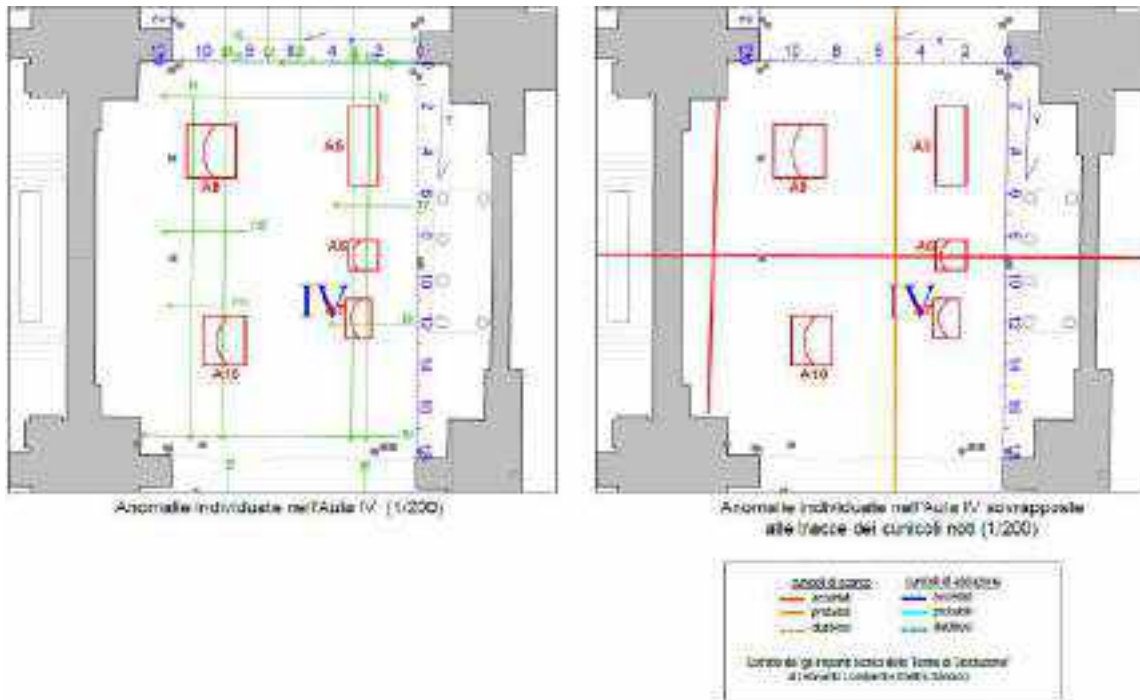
Planimetria dell'Aula IV con sezioni GPR e con sovrapposte le anomalie rilevate e le tracce dei cunicoli noti.
